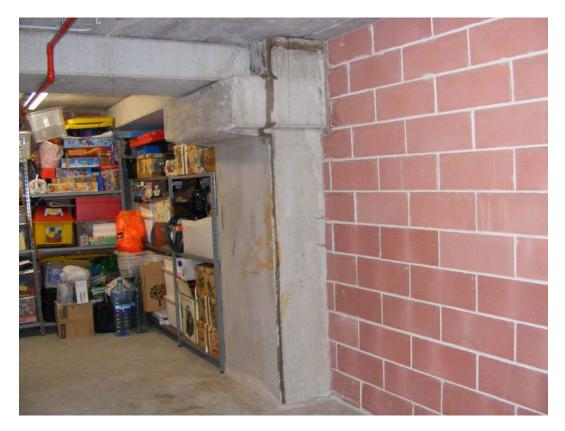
Le venute di acqua al piano inferiore. Autorimessa 5 Box 49
